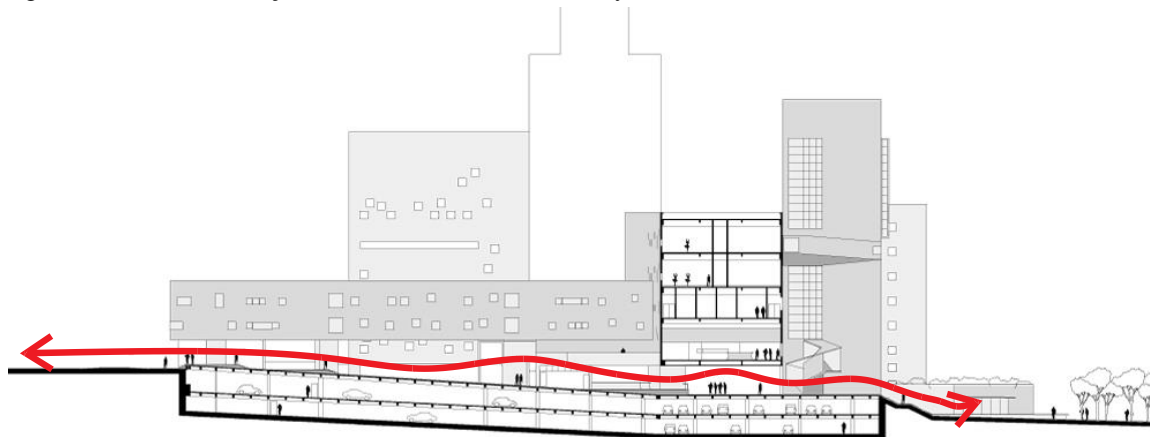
Corte da Praça das Artes Fonte Archdaily
